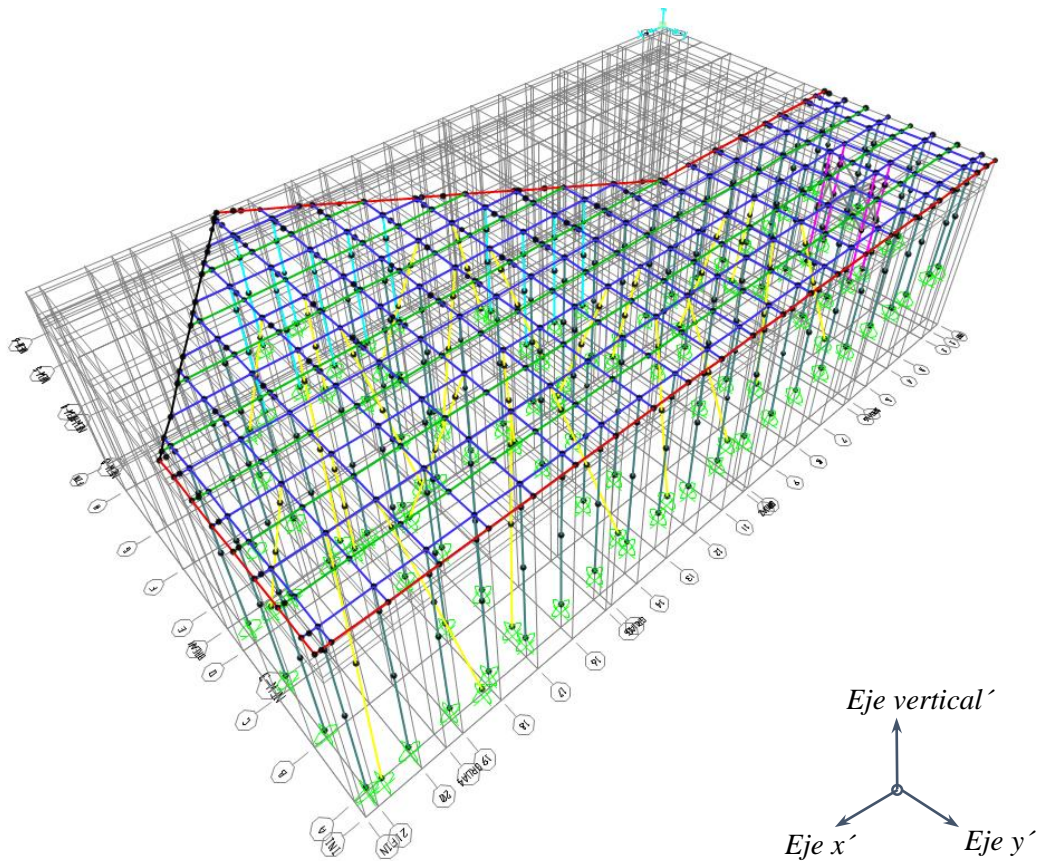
Vista tridimensional n°1 - principales direcciones horizontales.
